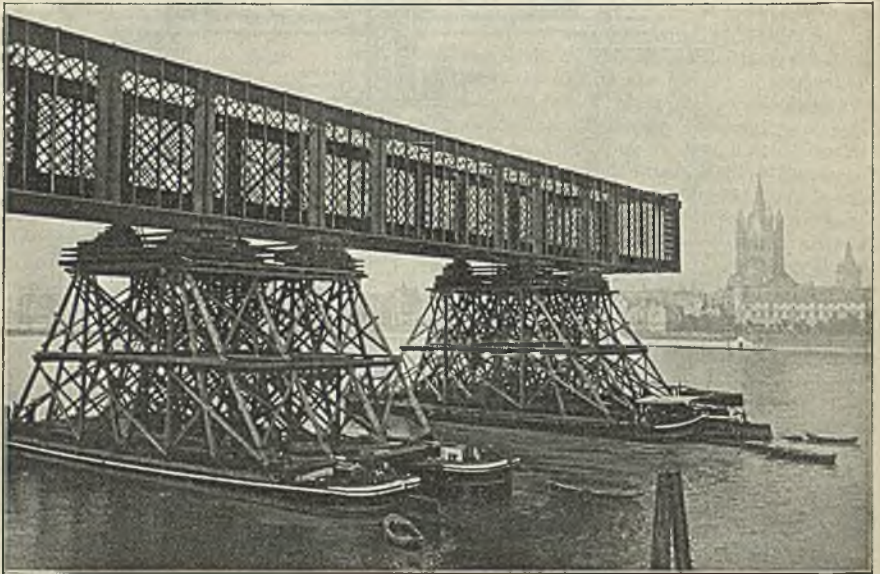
Abschleppen des Schwimmgerüsts mit einem Gitterträger der alten Eisenbahnbrücke zu Köln.
